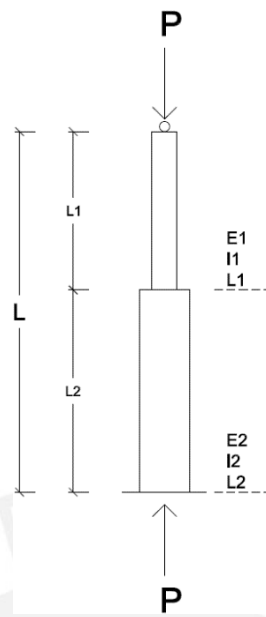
Columna de sección compuesta. Apoyos empotrado-articulado.
